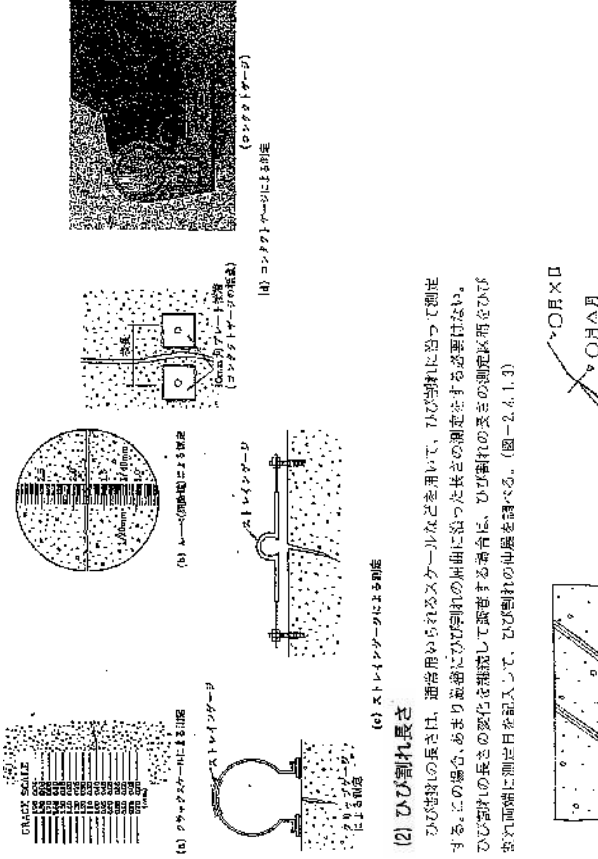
曲げひび割れ幅の測定
